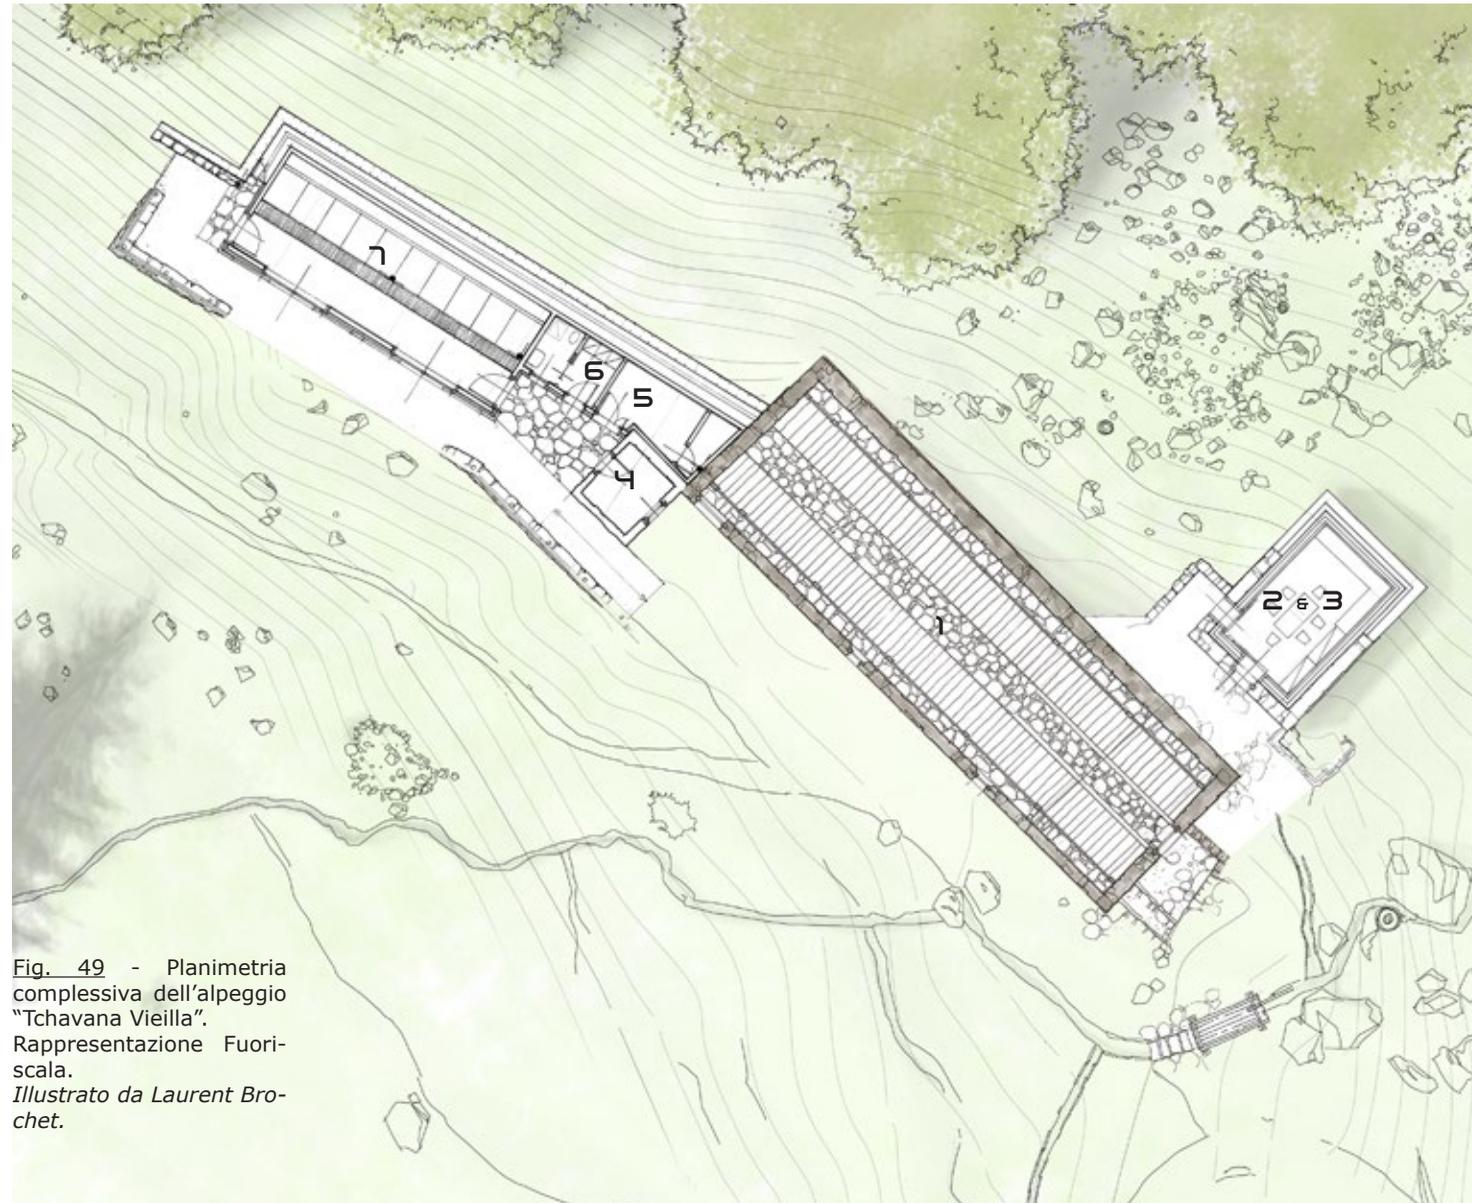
Planimetria complessiva dell'alpeggio "Tchavana Vieilla". Rappresentazione Fuoriscalda. Illustrato da Laurent Brochet.
